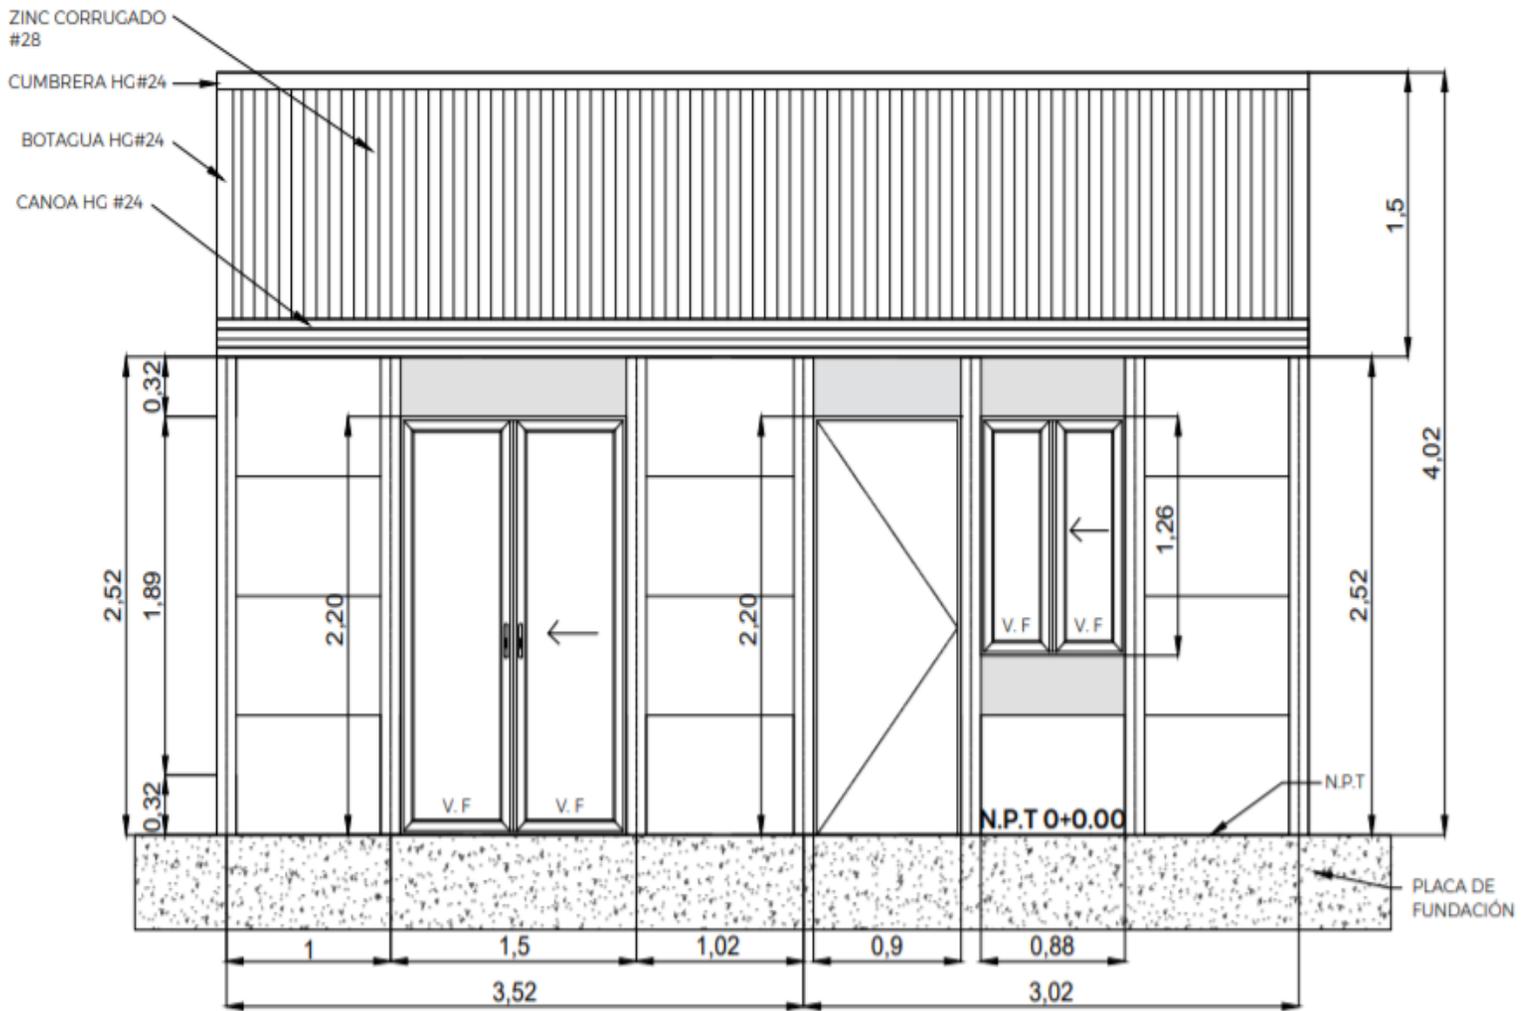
Elevación Frontal Sistema Prefabricado – Cubierta de 1 agua
